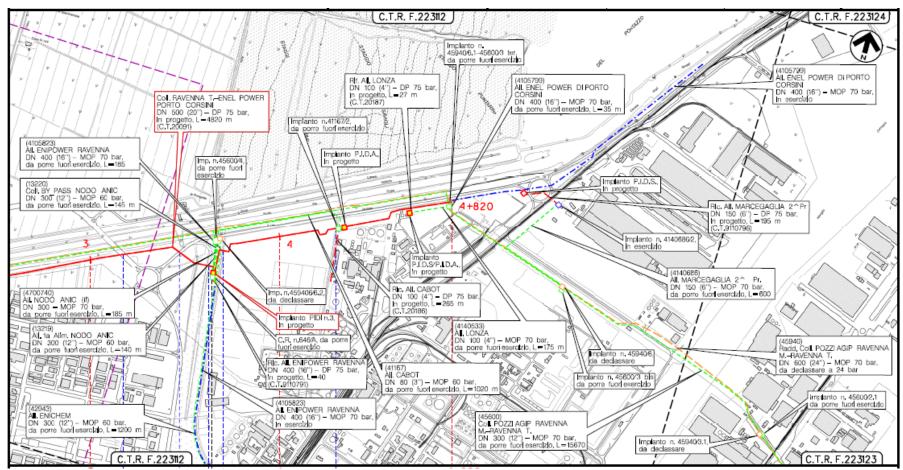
B: Stralcio planimetria CTR con localizzazione dell'area di intervento (Coll. Ravenna T. – ENEL POWER PORTO CORSINI)
